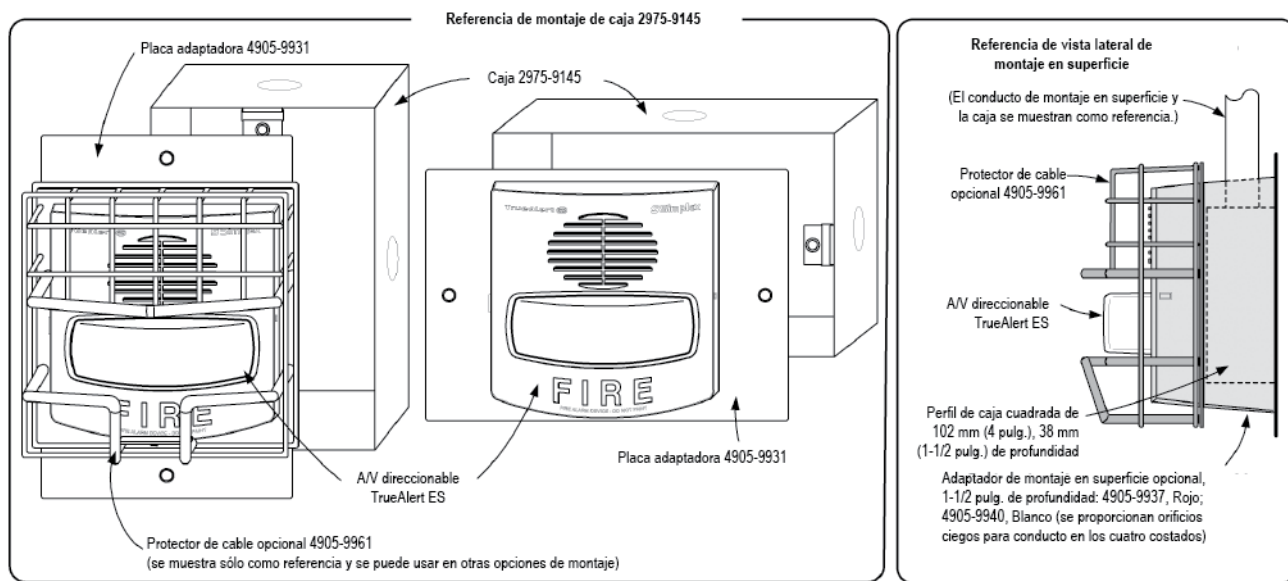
Referencia de instalación de montaje en superficie y placa adaptadora
